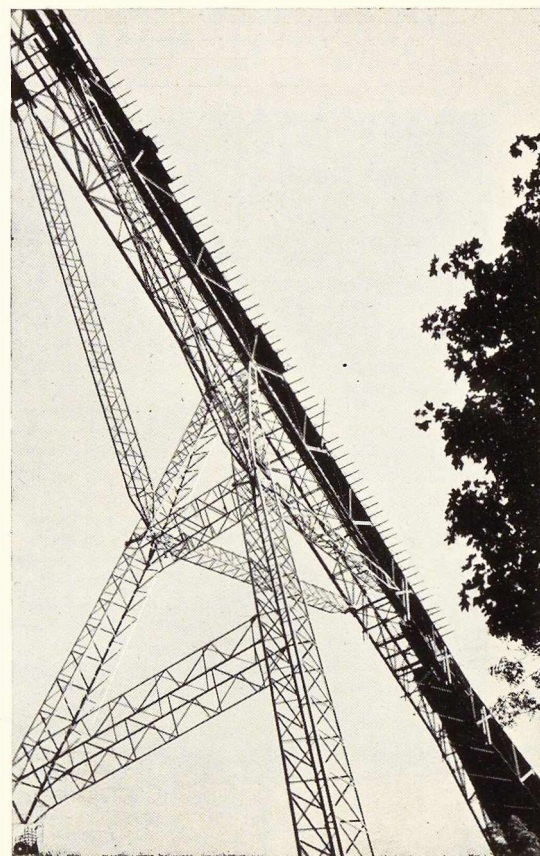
Montage des poutres au droit de la rivière à l'aide de poussards.
